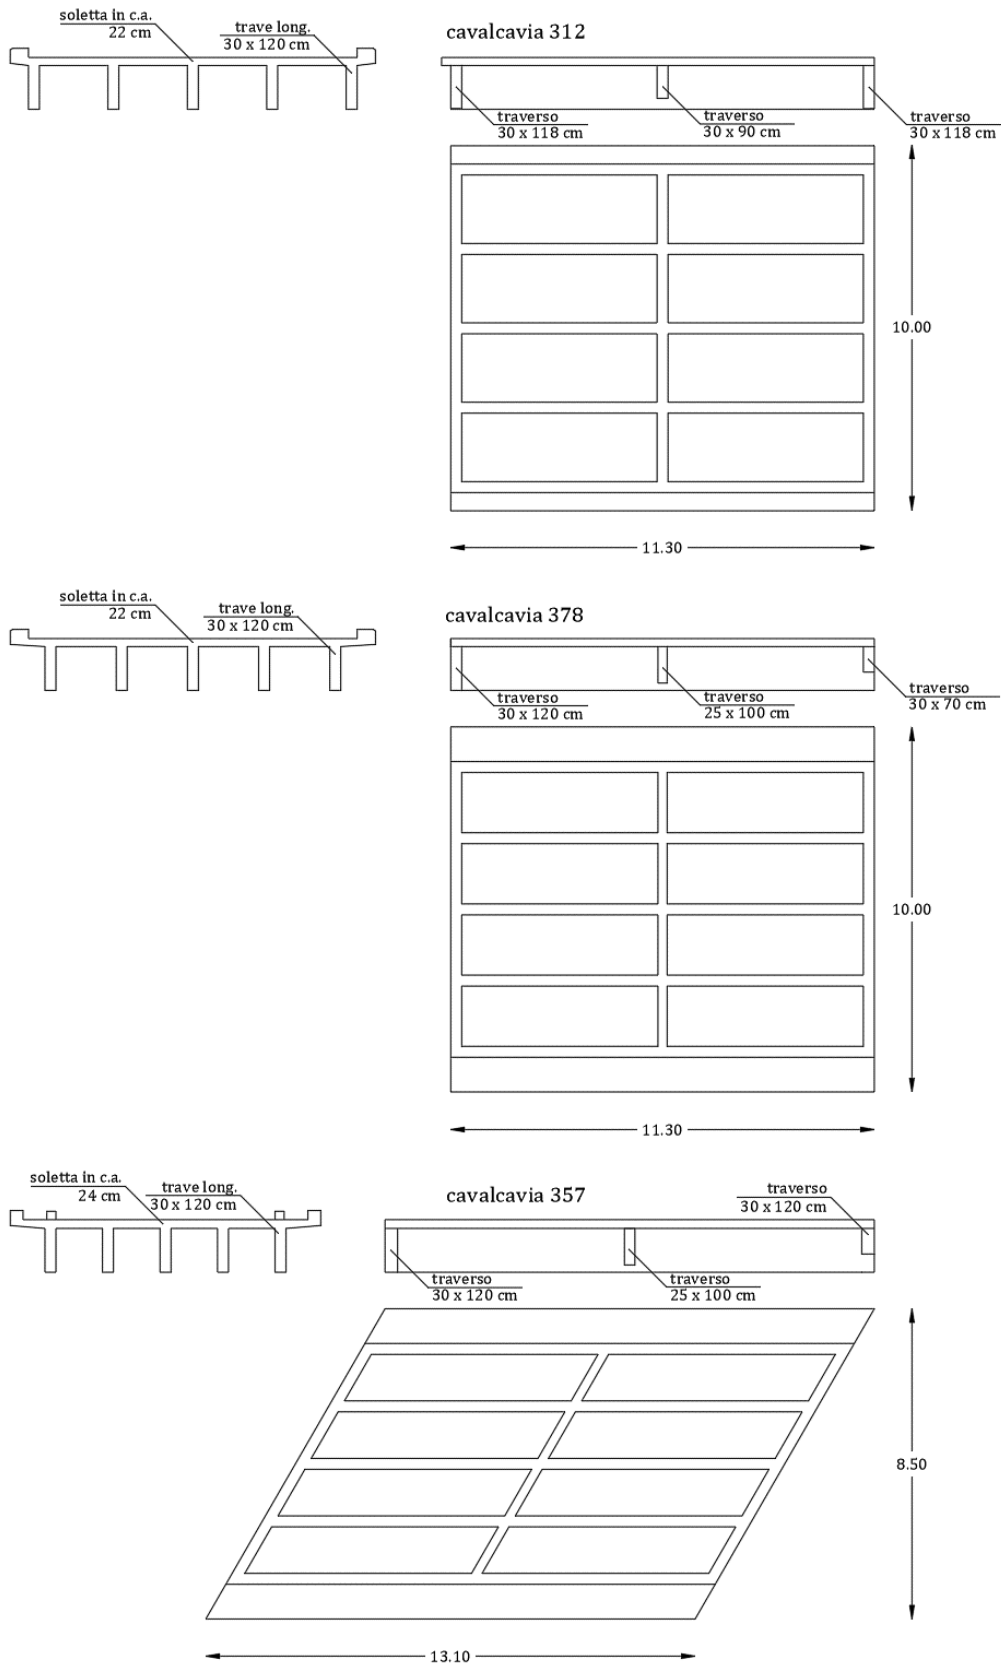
Sezione, prospetto e pianta degli impalcati laterali
